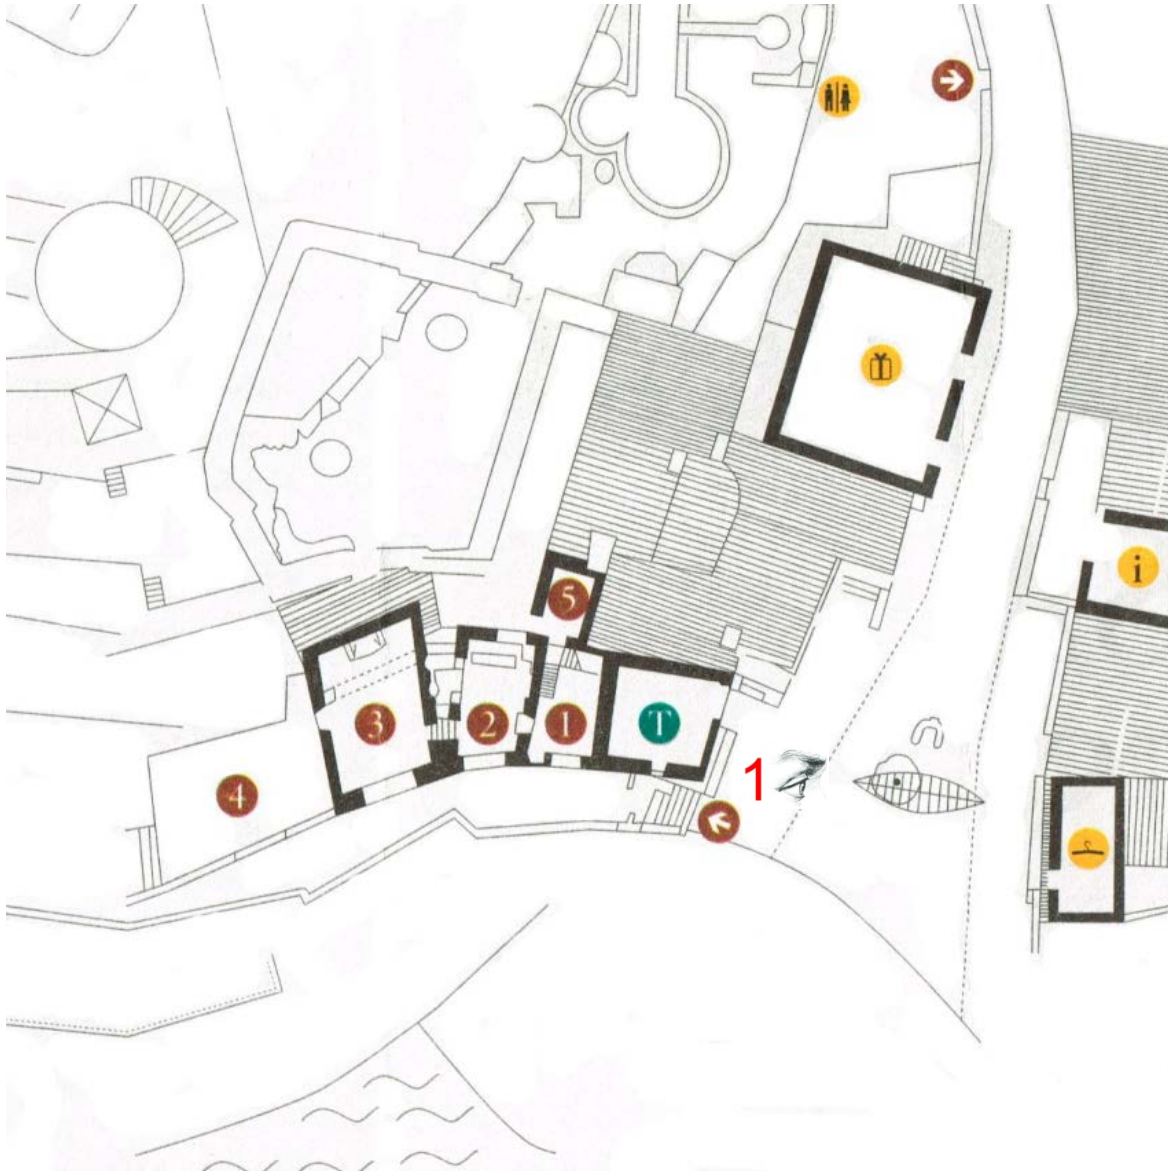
Planta Baja de Casa-Museo Salvador Dalí-Portlligat. S/E
